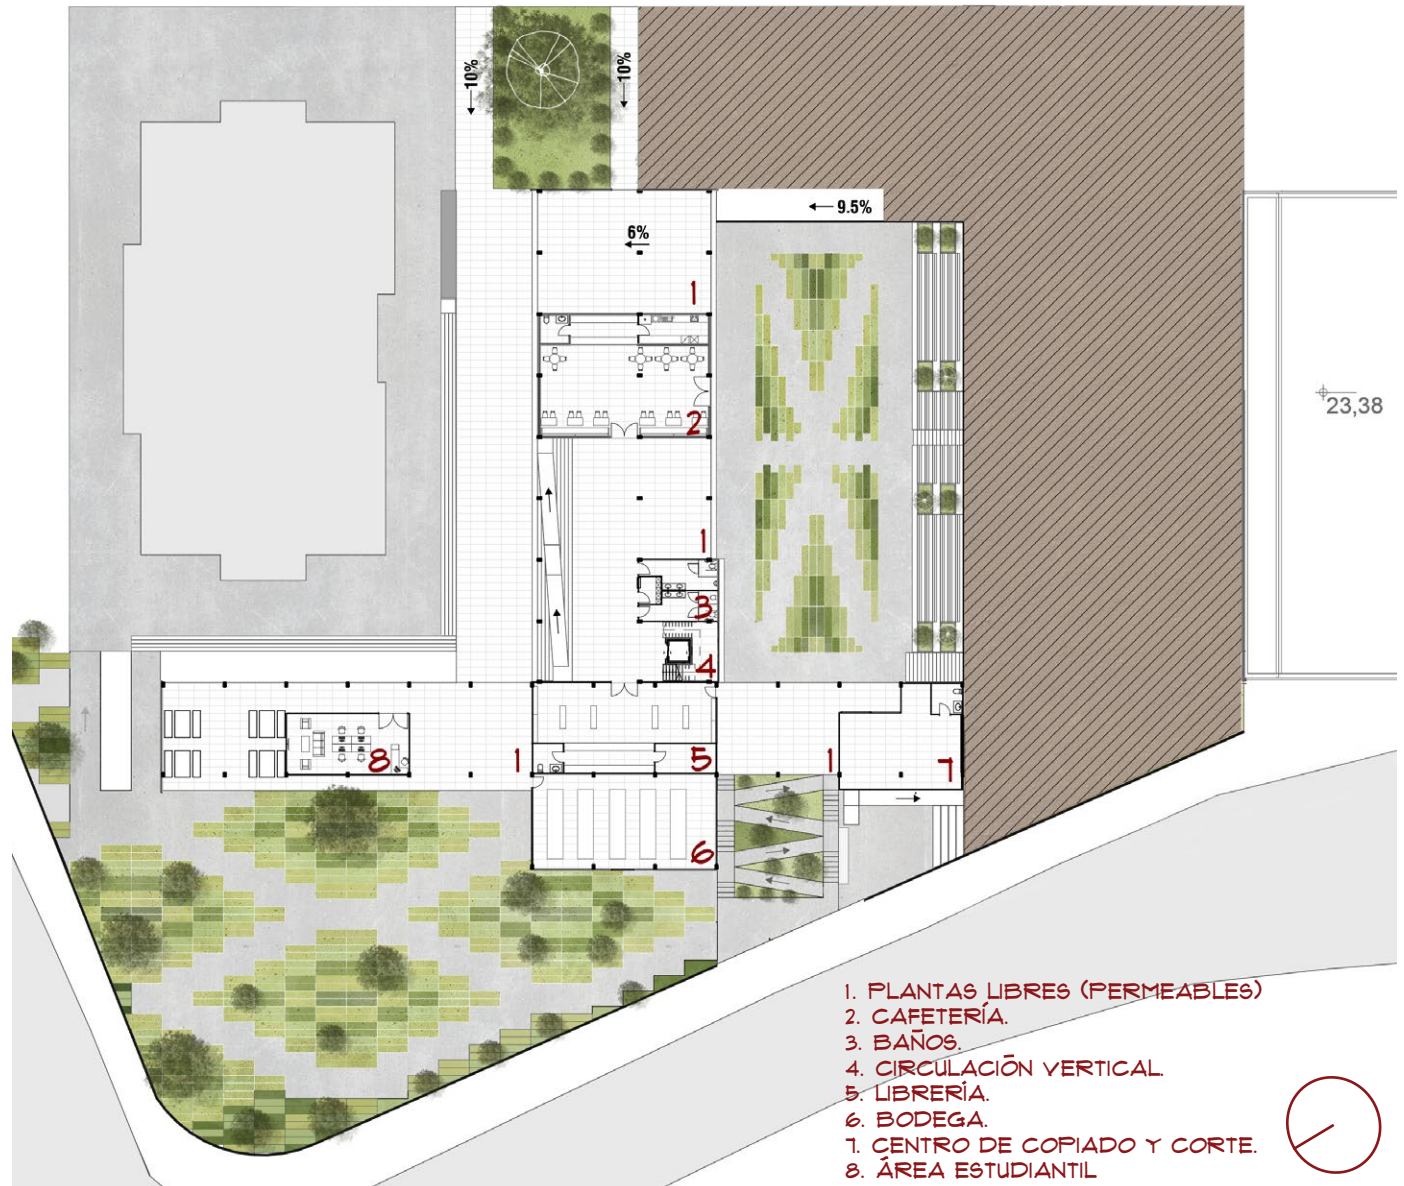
Planta Baja y áreas verdes (cancha y área verde trasera).
